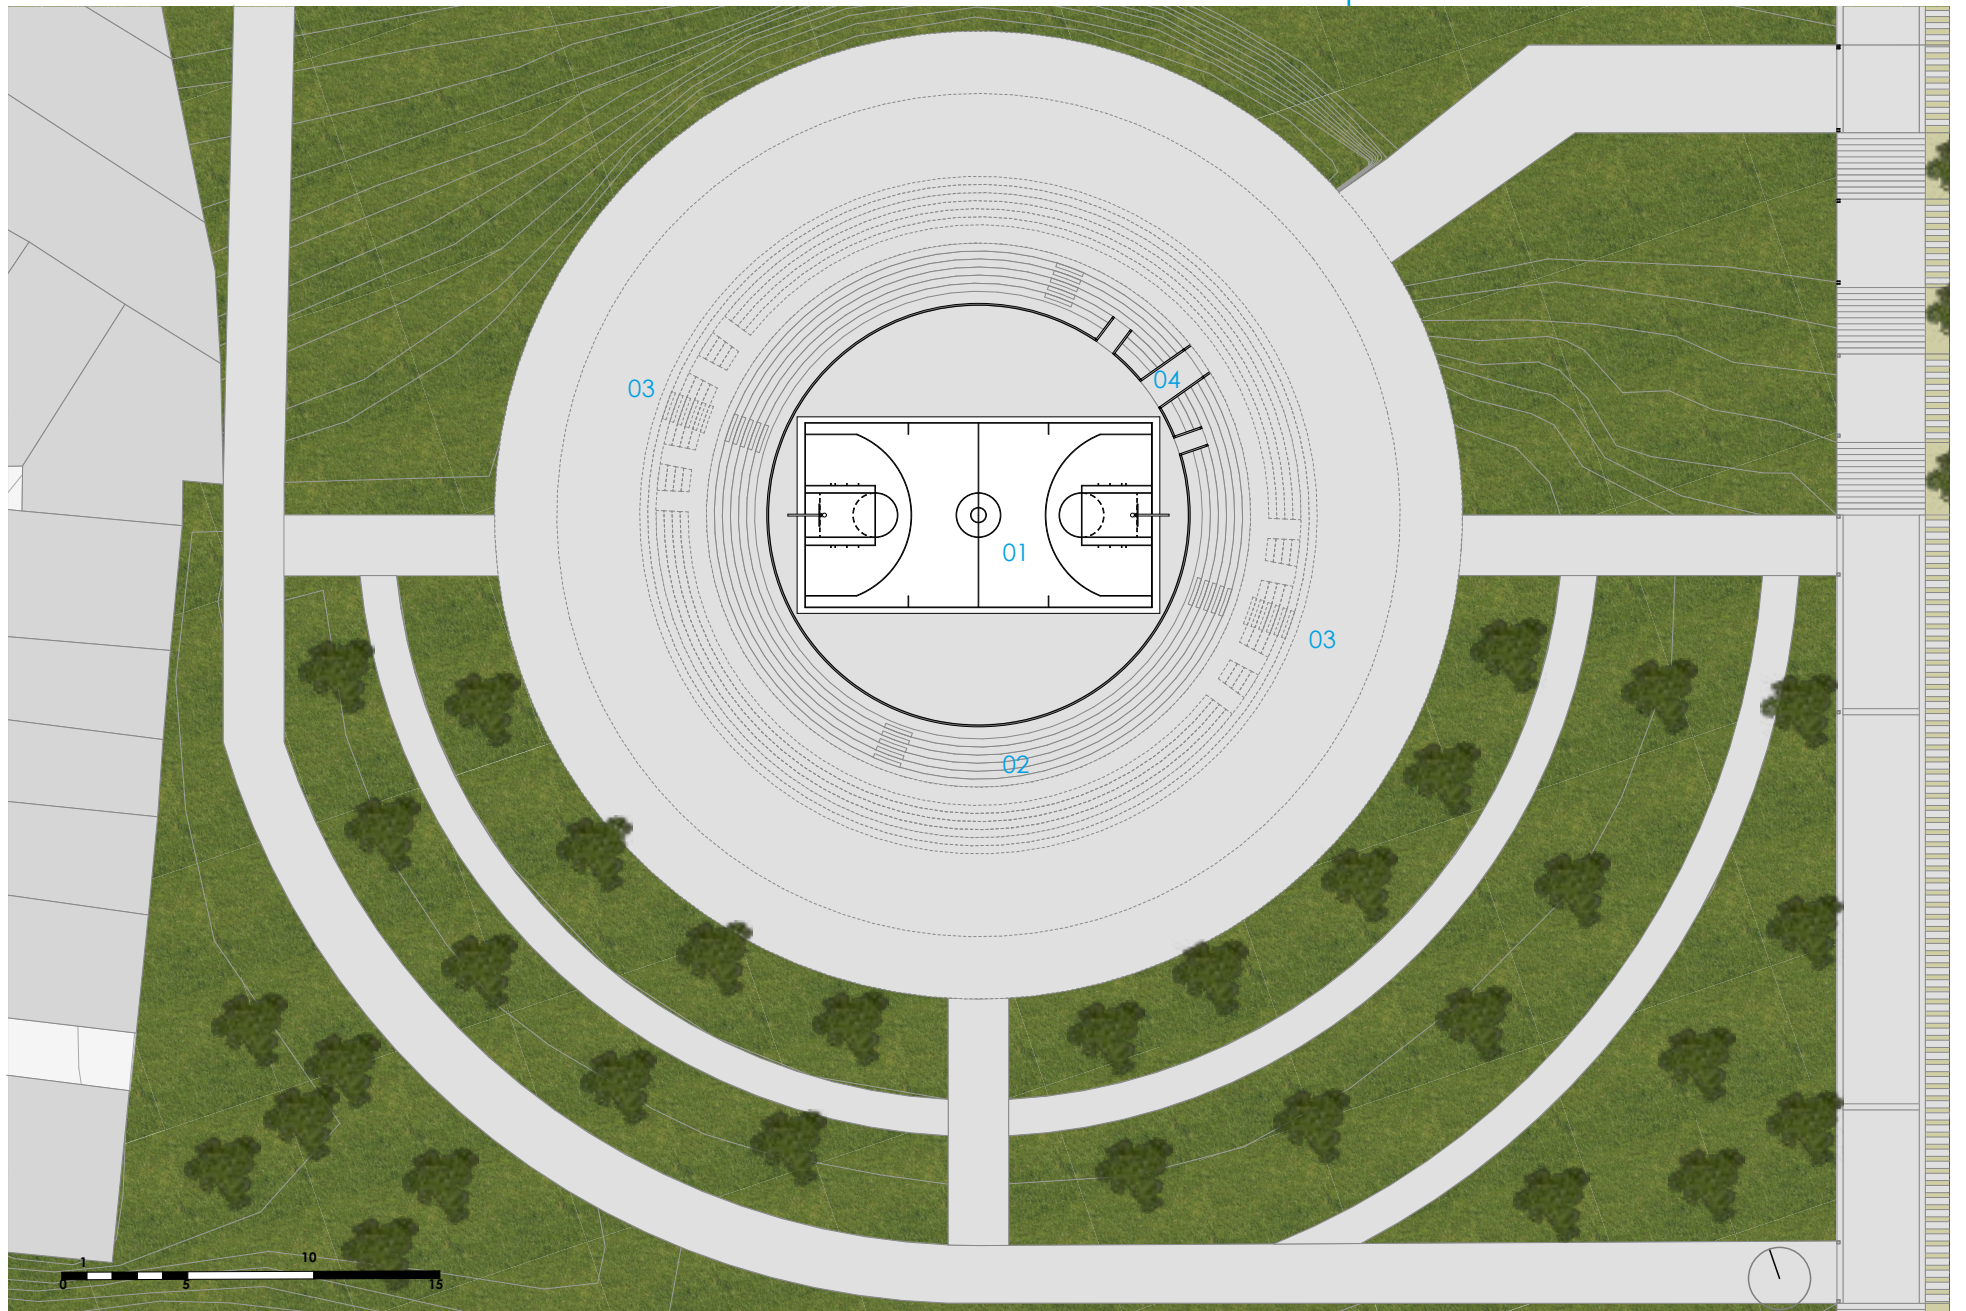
| Planta plaza de toros, proyecto arquitectónico. | Elaboración: Propia
